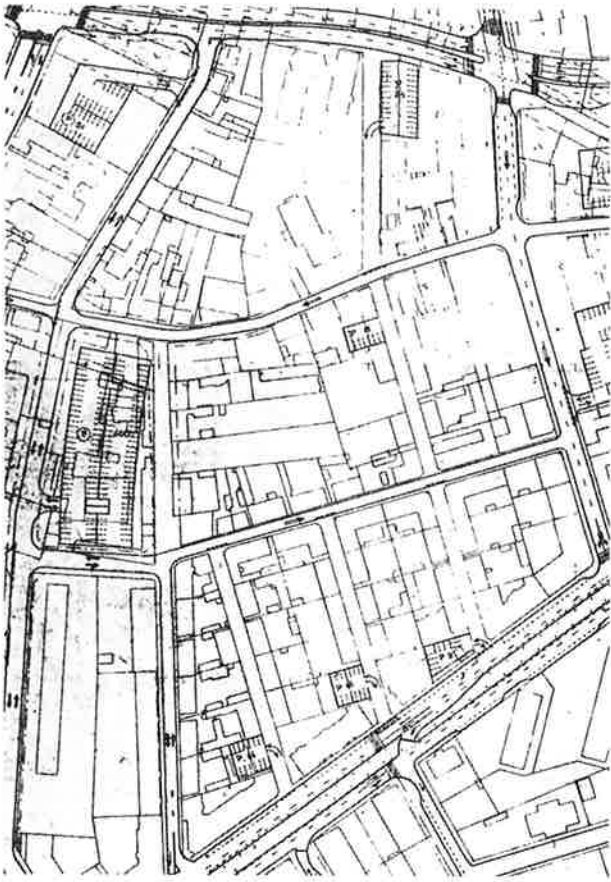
a. Nöden. Skiss till förnyelseplan. Arkitekt SAR Britt Pedersen.
